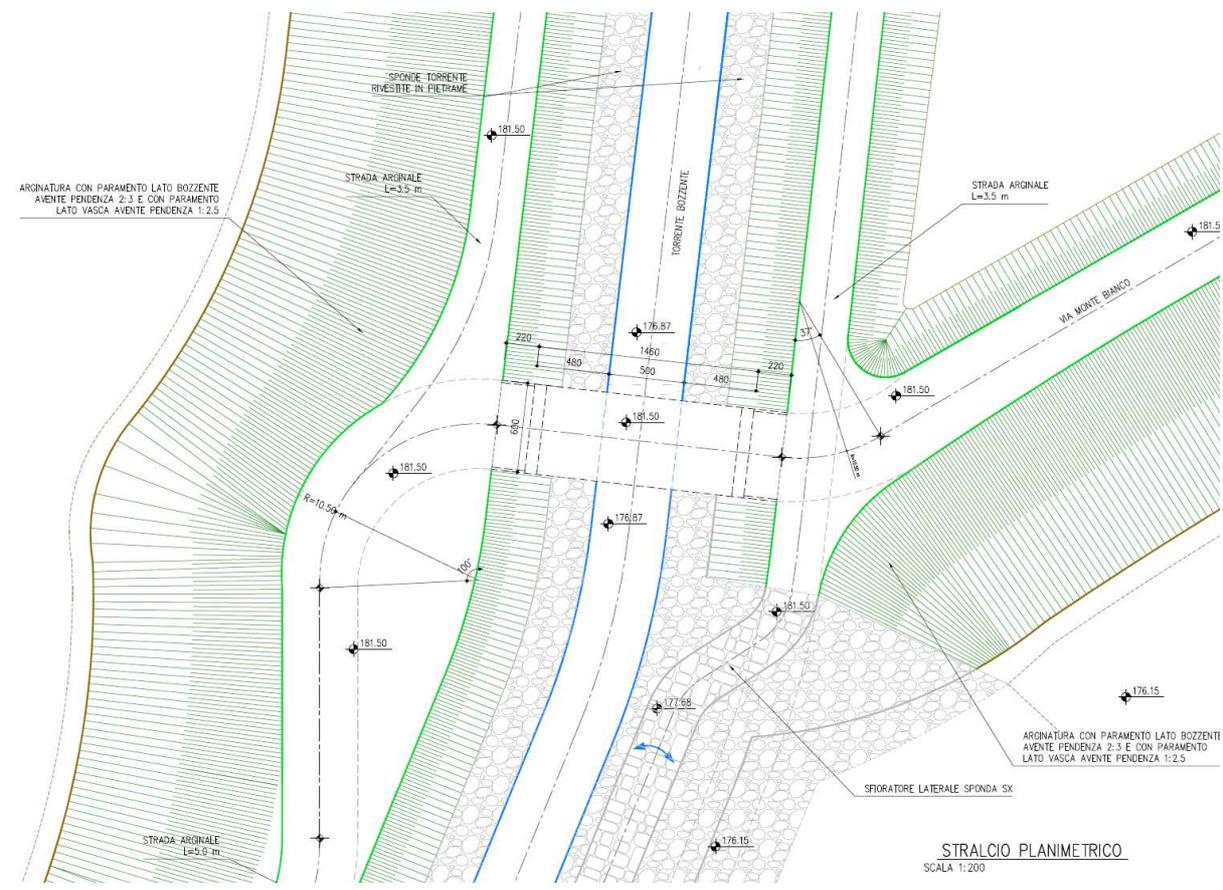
stralcio planimetrico – manufatto di attraversamento Via Monte Bianco
